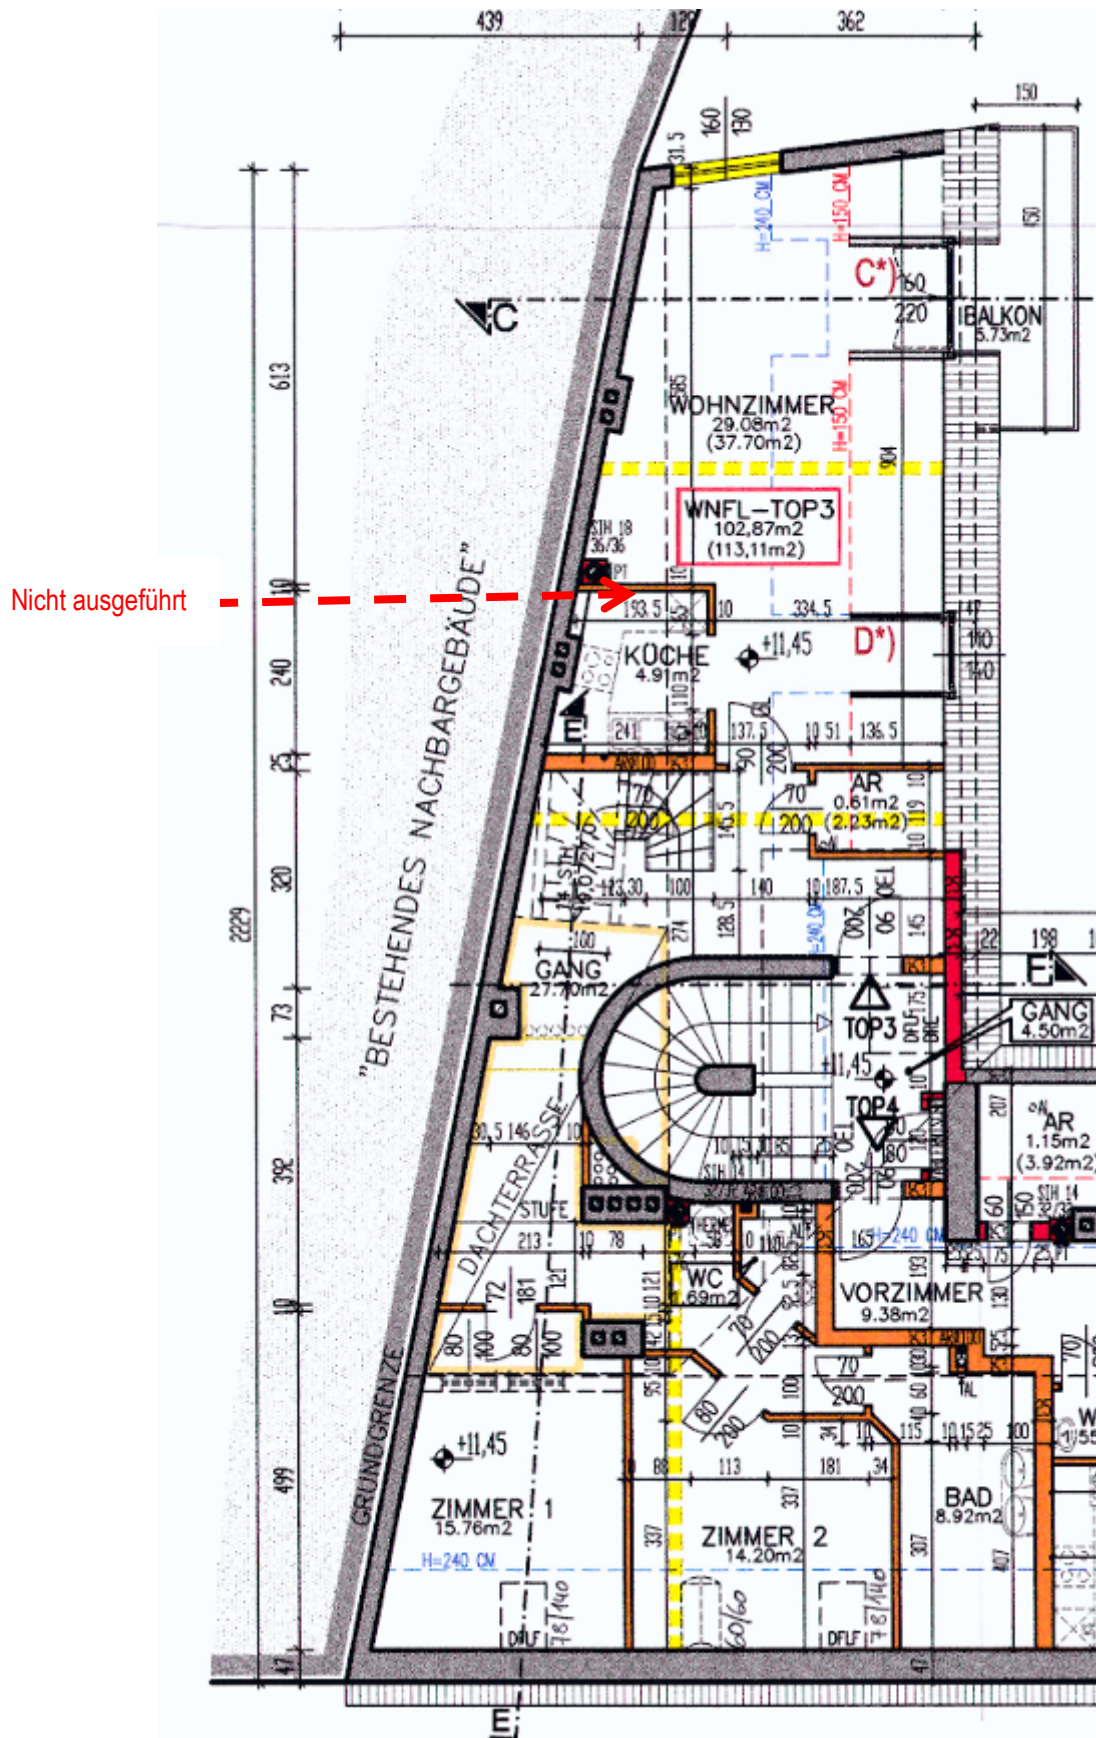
Grundriss Wohnung Top D 3 (Einreichplan 03.12.2002)
